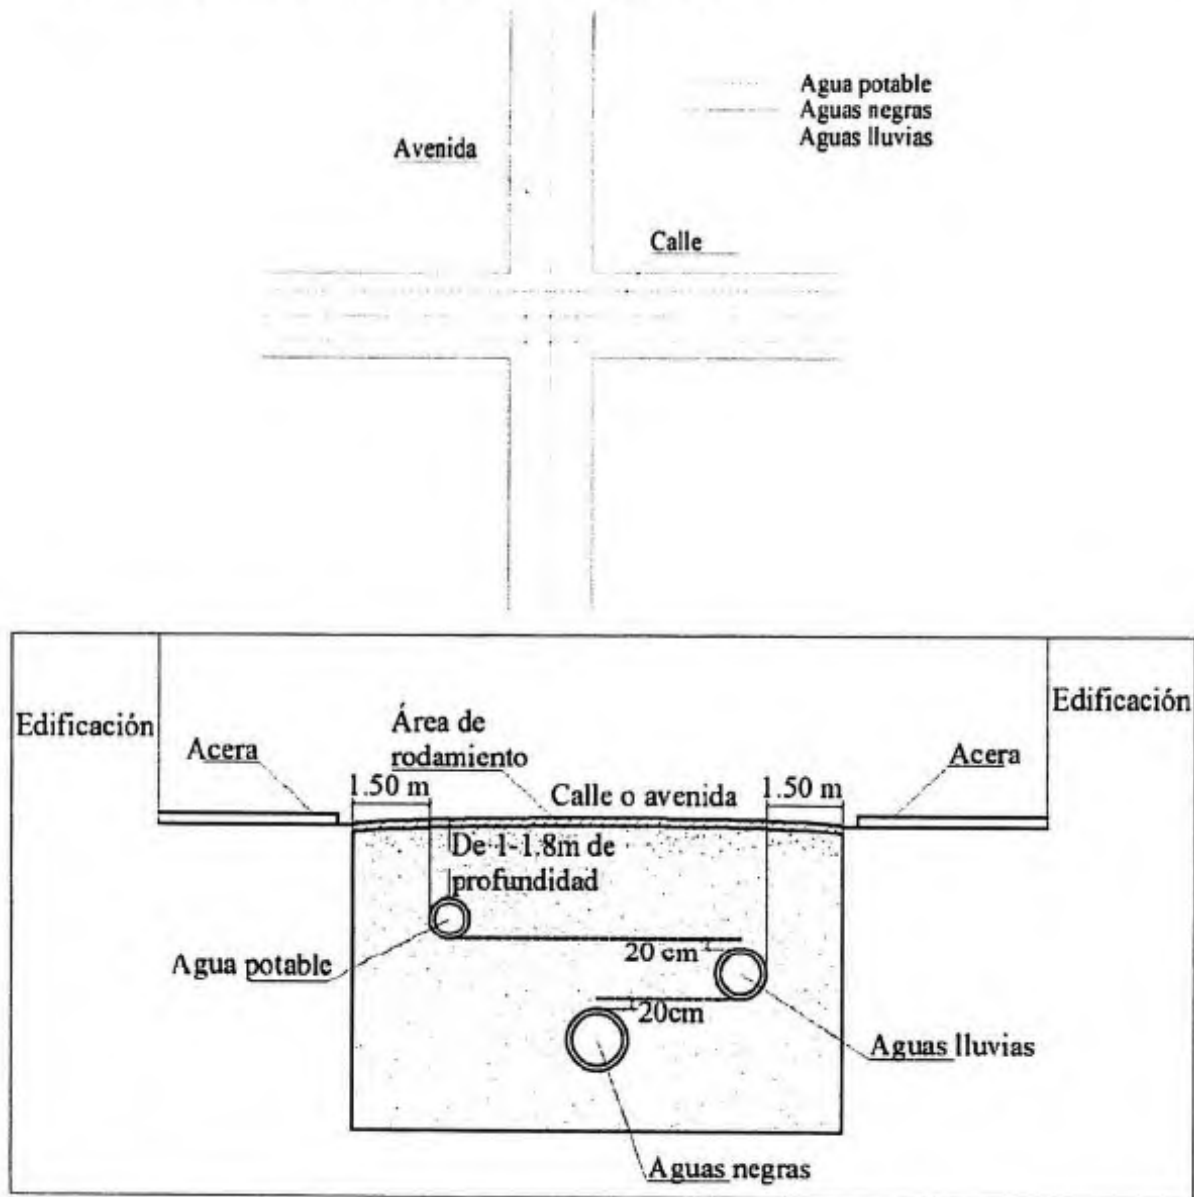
Distancias de tuberías de acueducto y alcantarillado.
